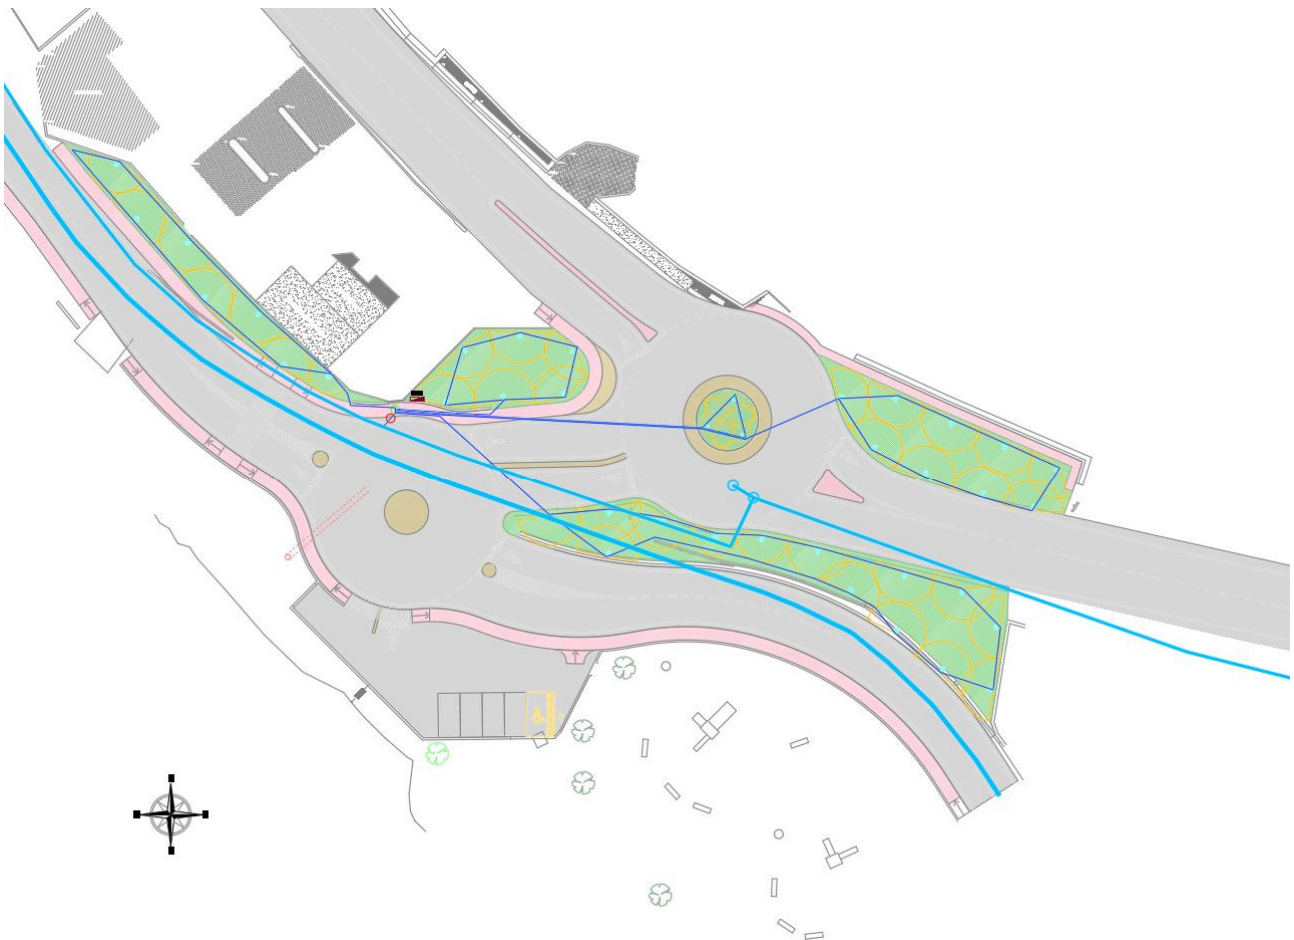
Planimetria con sistema di irrigazione in progetto, estratto della Tavola 12 - Planimetria impianto irrigazione
